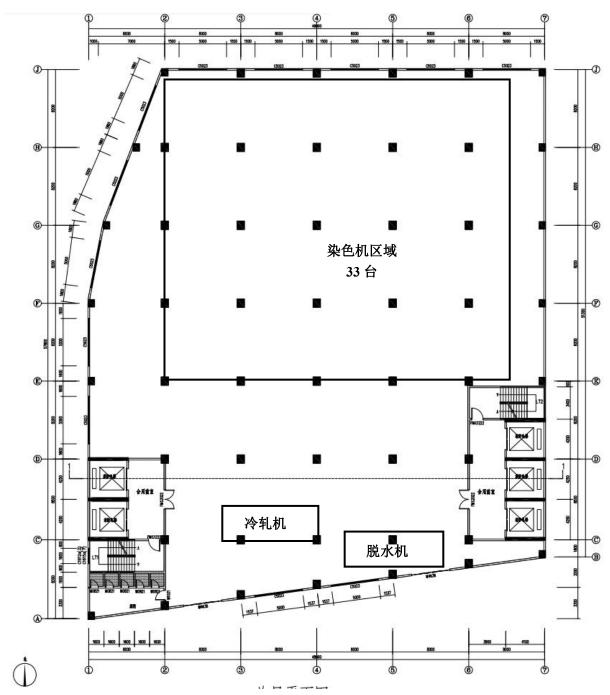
原有项目 (B 栋厂房) 1 楼平面布置图
